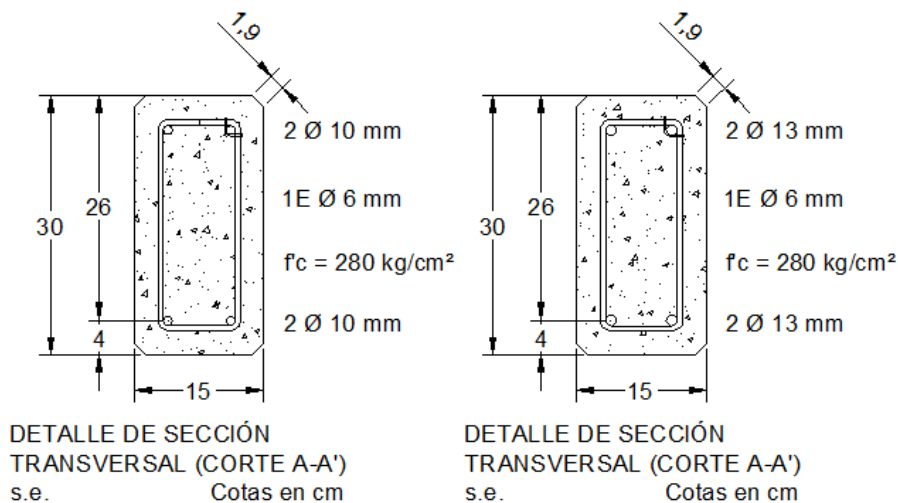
Sección transversal de las traves con barras de AR longitudinal a tensión de 10 y 13 mm
